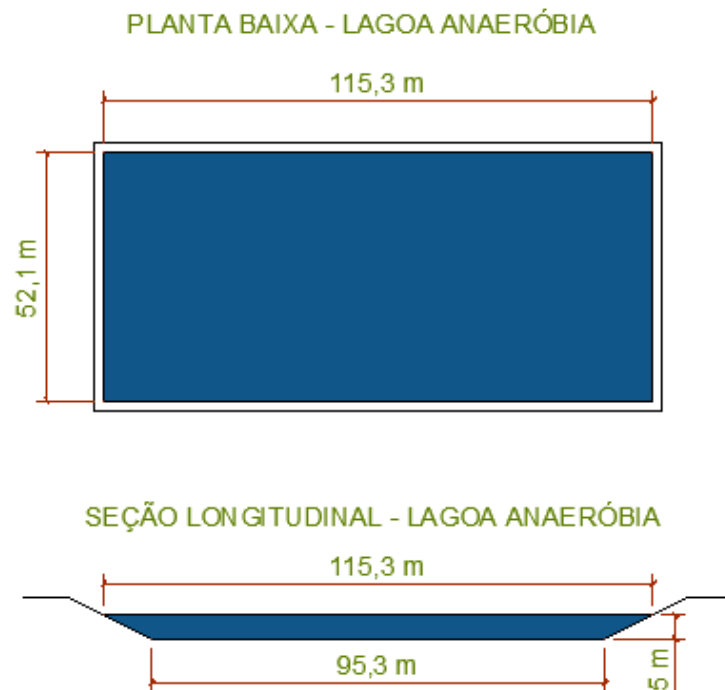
Detalhes da planta baixa e seção longitudinal das lagoas anaeróbias
